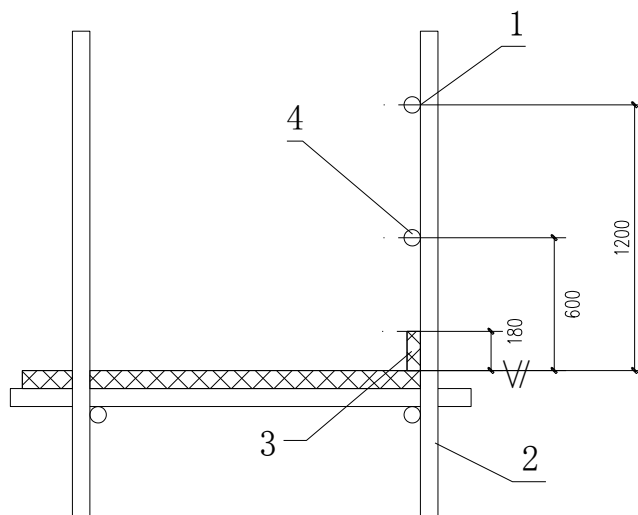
栏杆与挡脚板示意图 (单位: mm)
